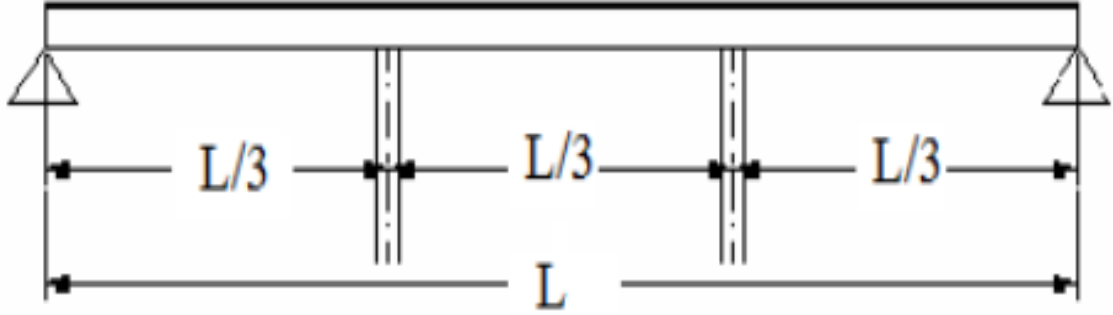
Kompozit kirişlere oturan doğrudan dökme ve prefabrik betonarme döşemeler
